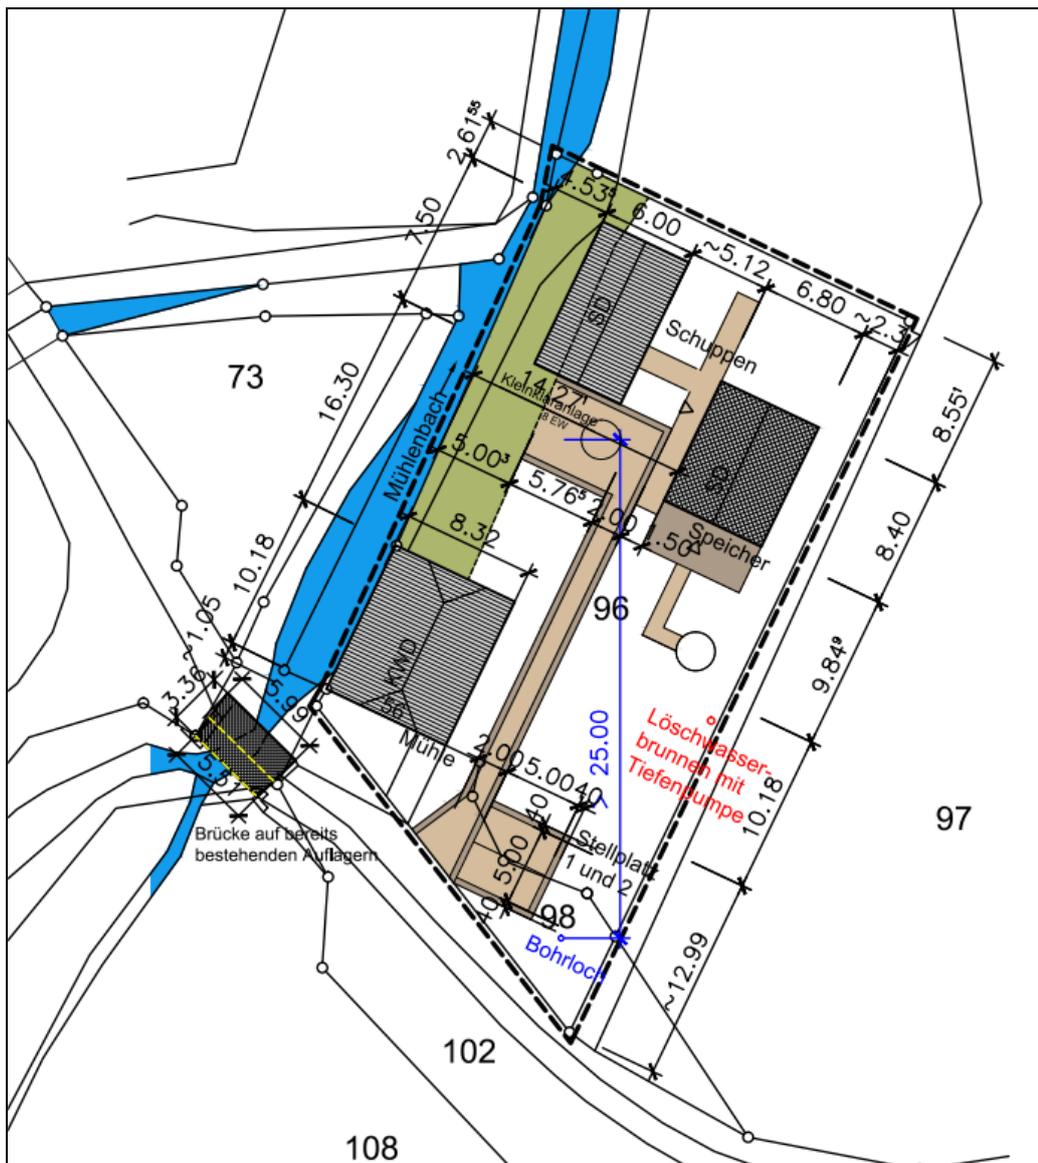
Lageplan des Vorhabens an der Burloer Mühle
